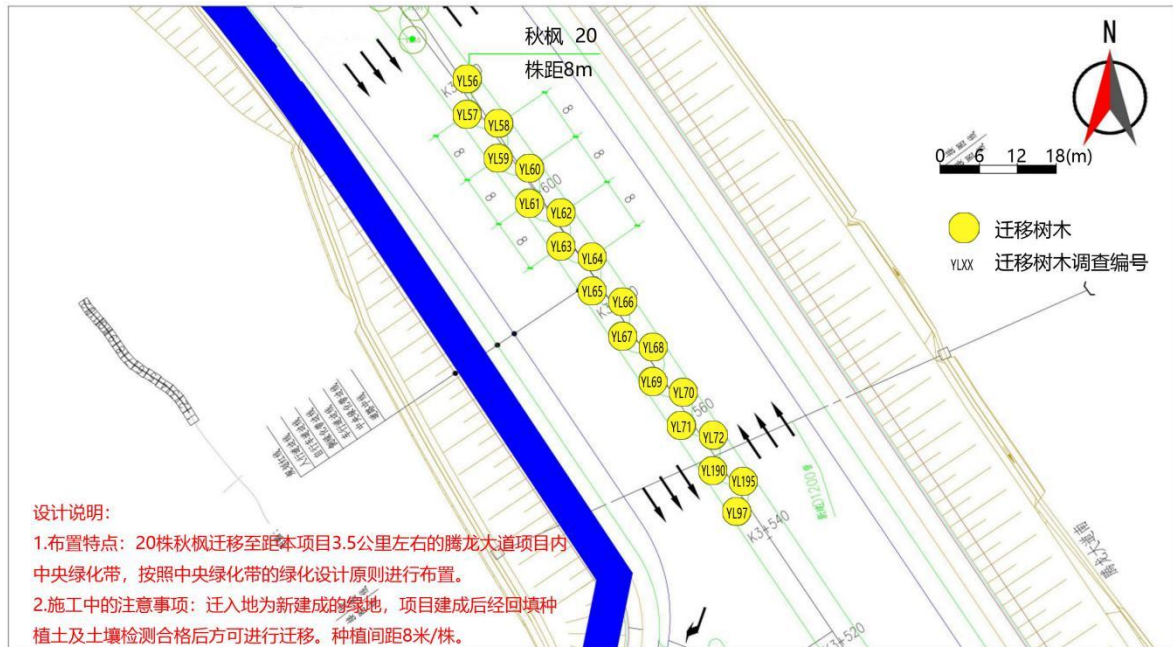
迁移安置平面图 (腾龙大道中央绿化带, 视源电子对面)
